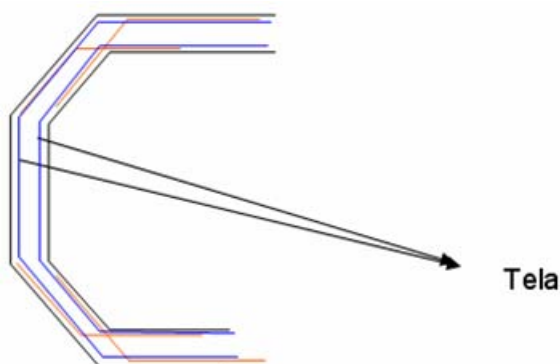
Colocação de armadura construtiva, para reforço da aduela, em vista do modelo de fixação adotado.
